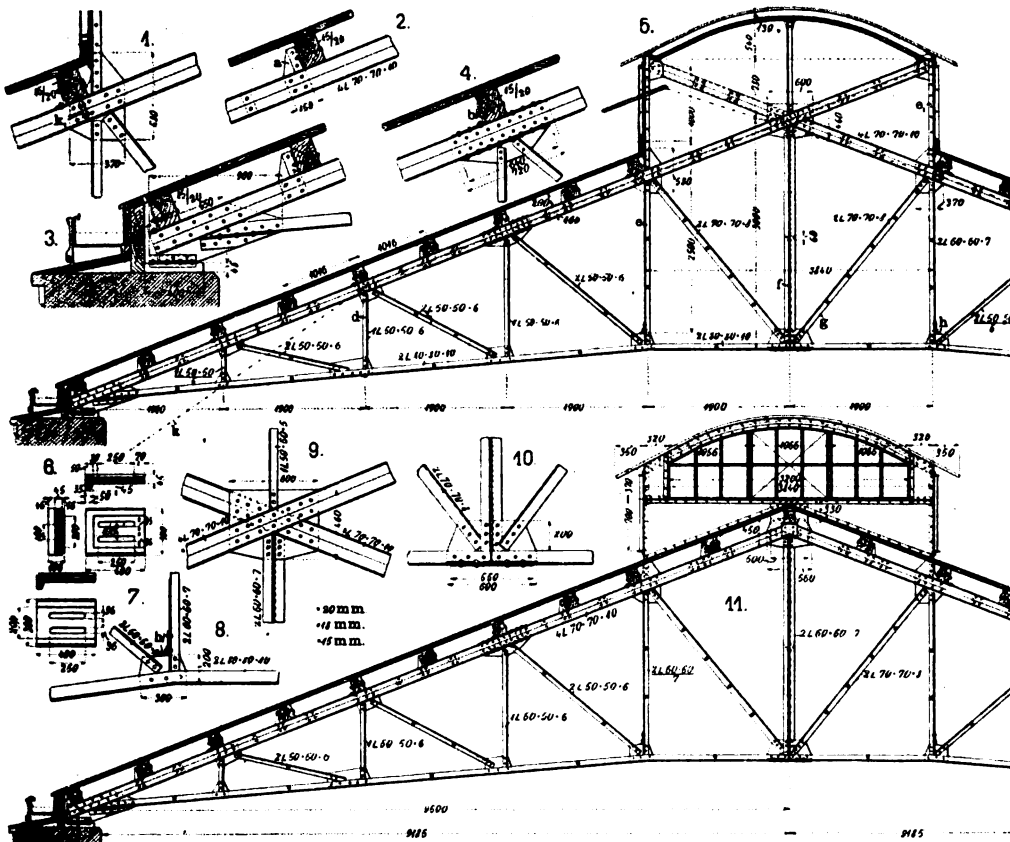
Dachkonstruktion für ein Kesselhaus.
